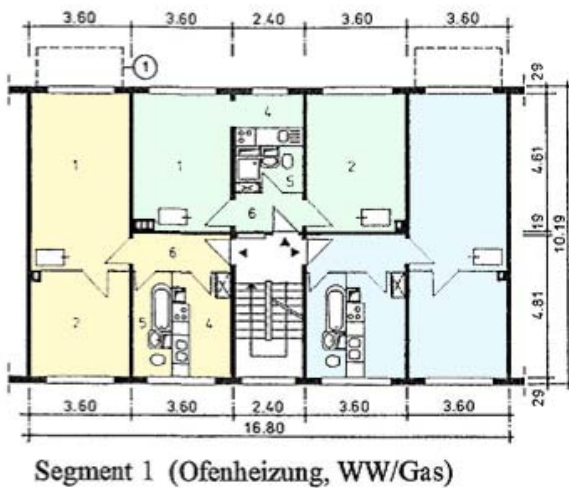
Grundrissbeispiele für Typ IW64 4 Etagen
